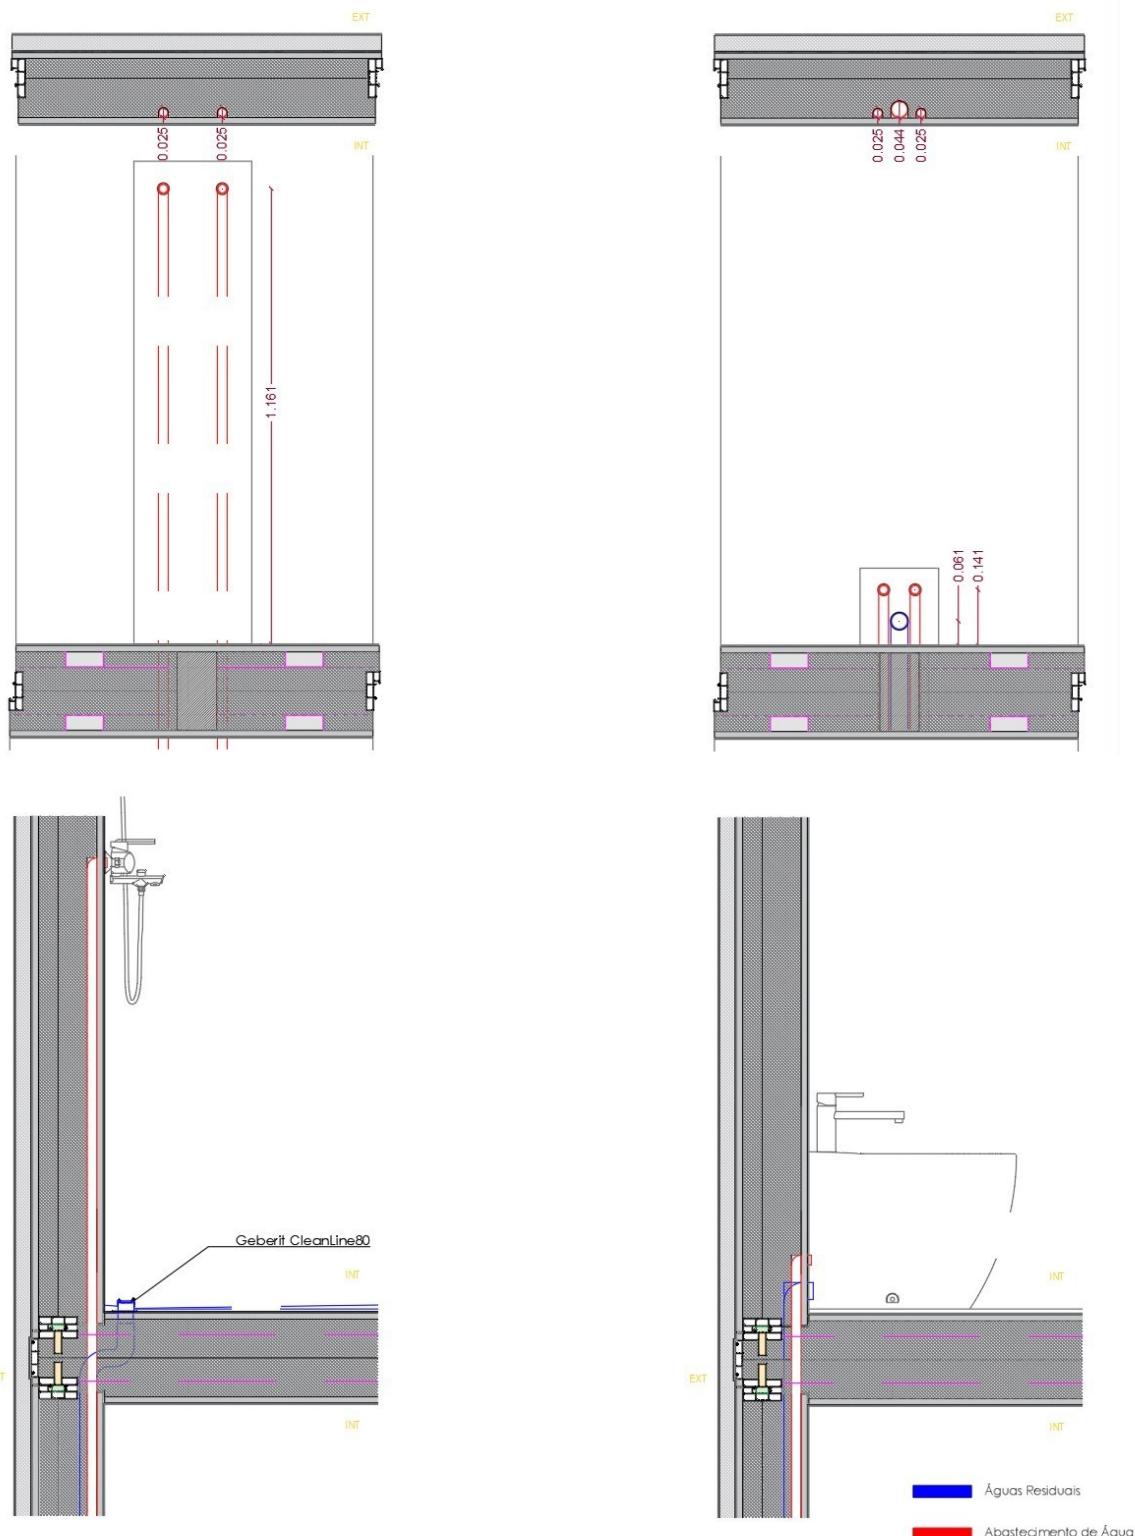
/ 28. Solução Final – Pormenor construtivo de parede/piso ligação hidráulica (duche e bidé respetivamente).
